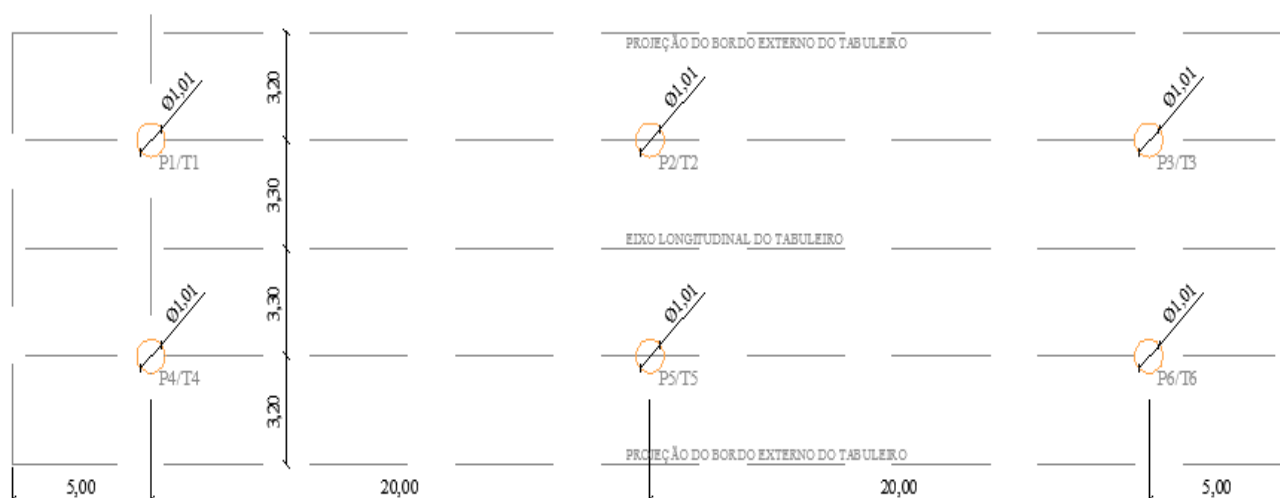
Locação dos pilares e fundação. Fonte: Autor (2018).
